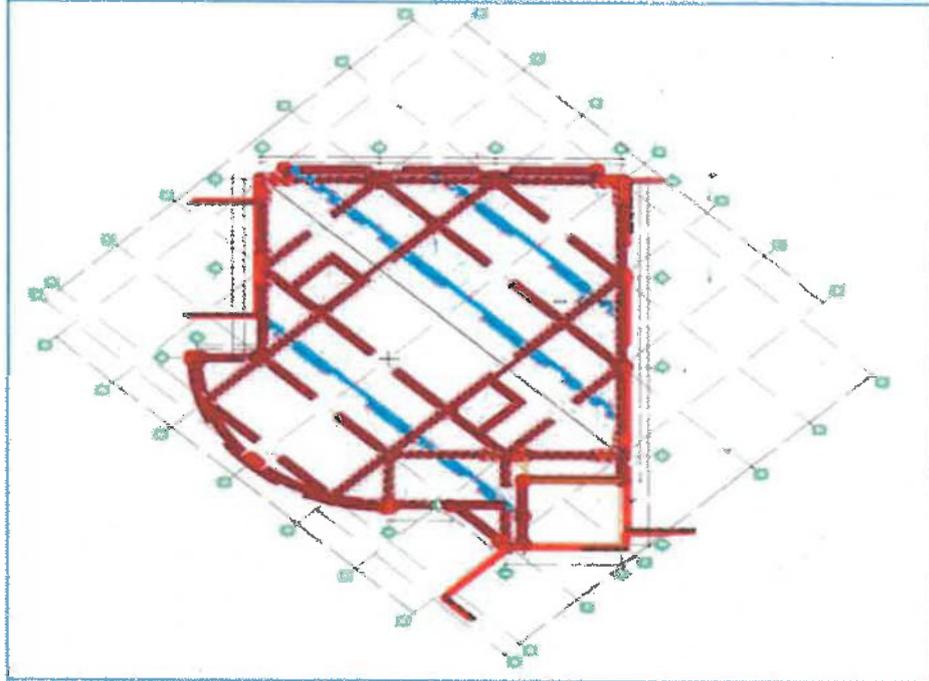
Plano estructural típico 1º y 2º nivel de vigas y aligerados
